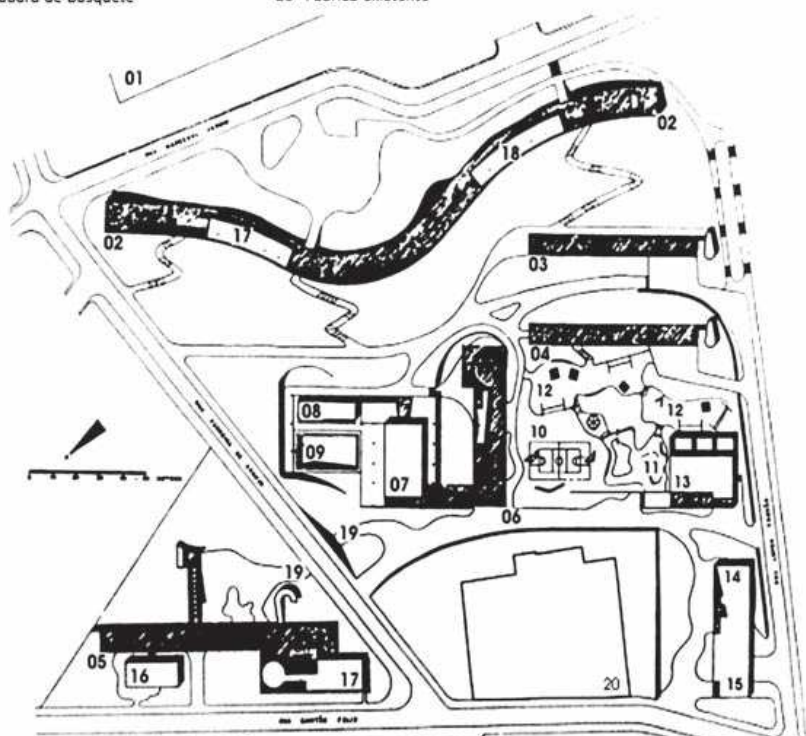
PLANTA GERAL DO CONJUNTO
